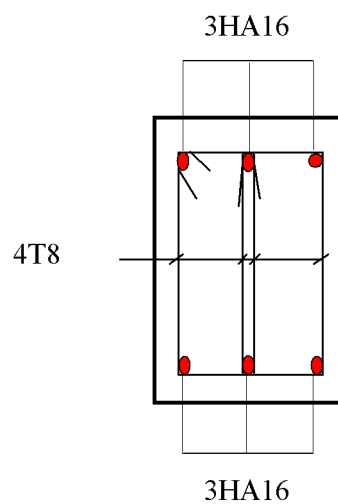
Coupe verticale des poutres secondaires au niveau des appuis
